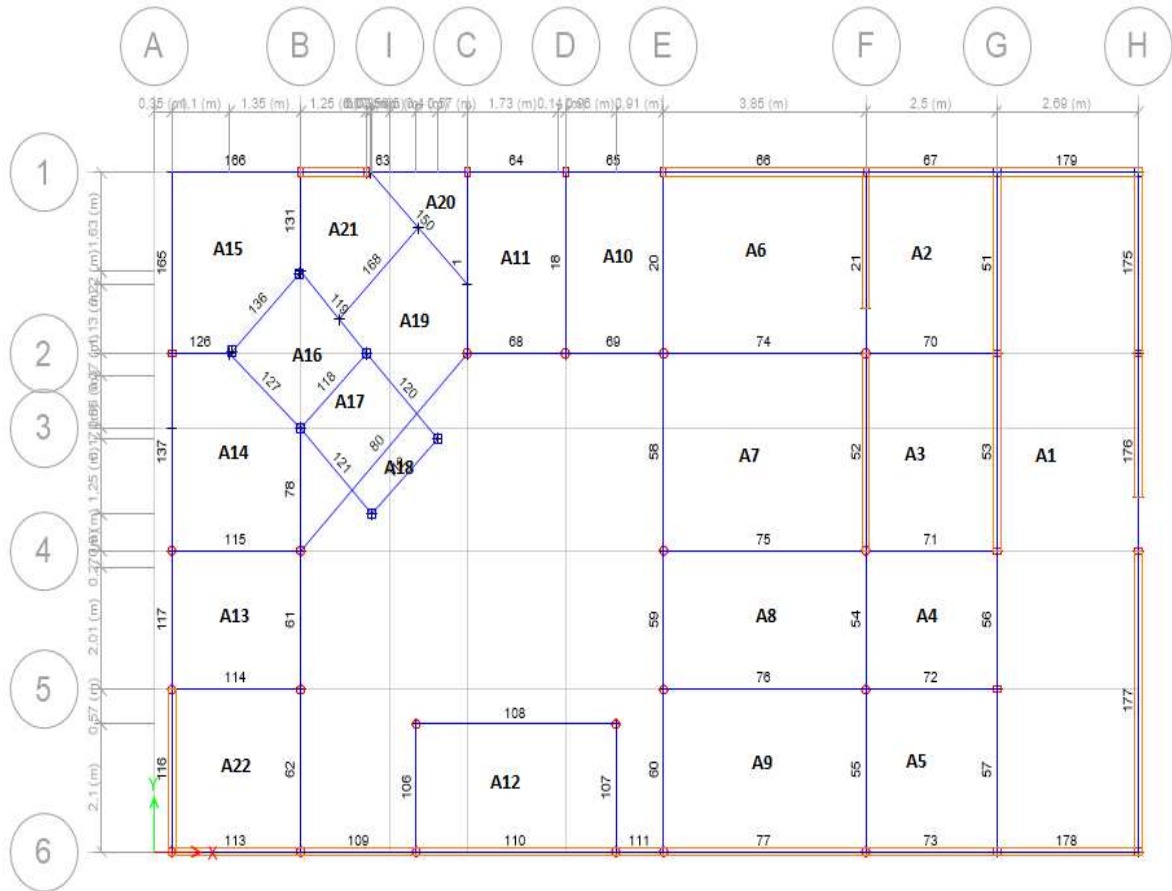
Planta primer piso, se observan los muros de albañilería (color rojo).
